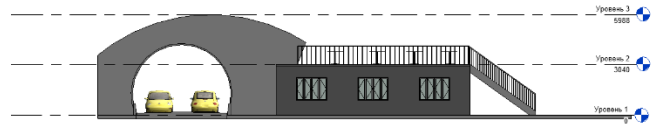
Архитектурно-планировочное решение (фасад - южный)
